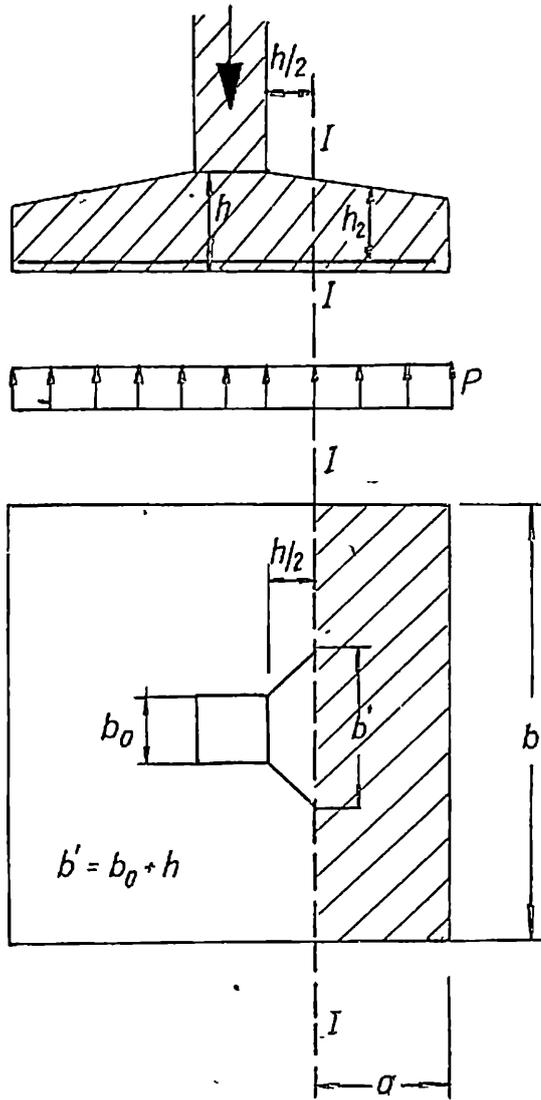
II. Расчетное сечение I-I для определения напряжения сцепления при отдельных фундаментах под колонны
